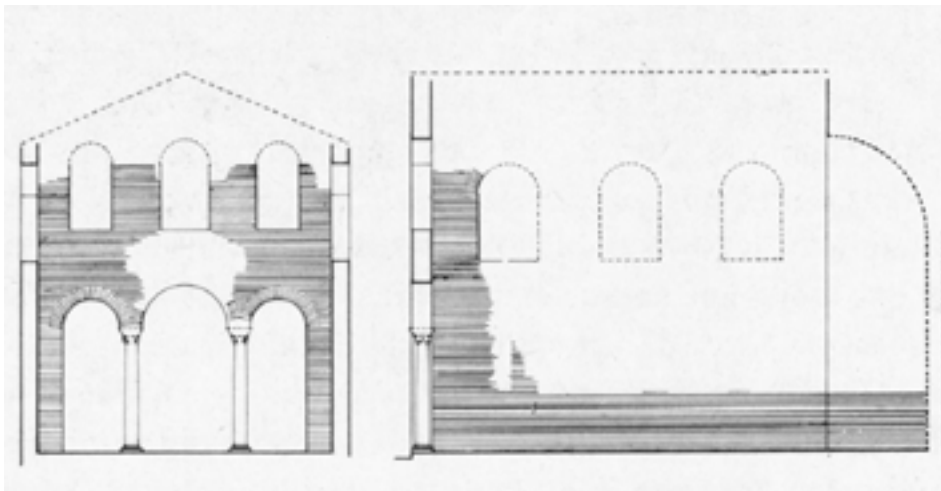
Ricostruzione della facciata e della parete nord dell'aula primitiva (da KRAUTHEIMER, CORBETT, FRANKL 1976).
